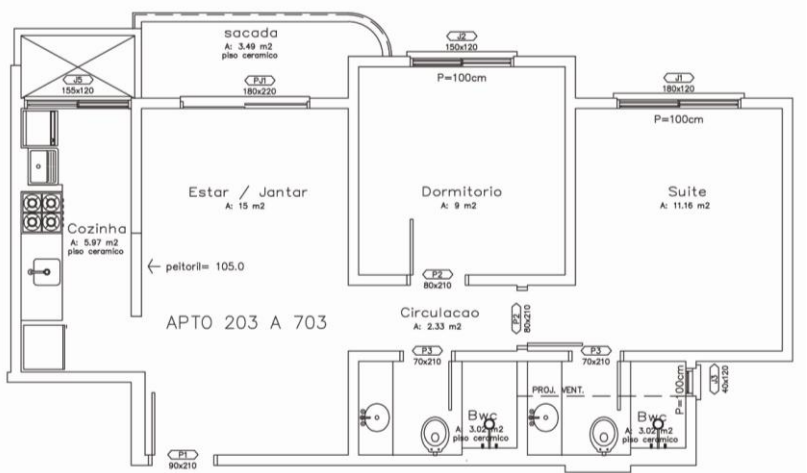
Planta baixa do apartamento padrão do Edifício Puerto Madero. Fonte: Bolzan (2002)
